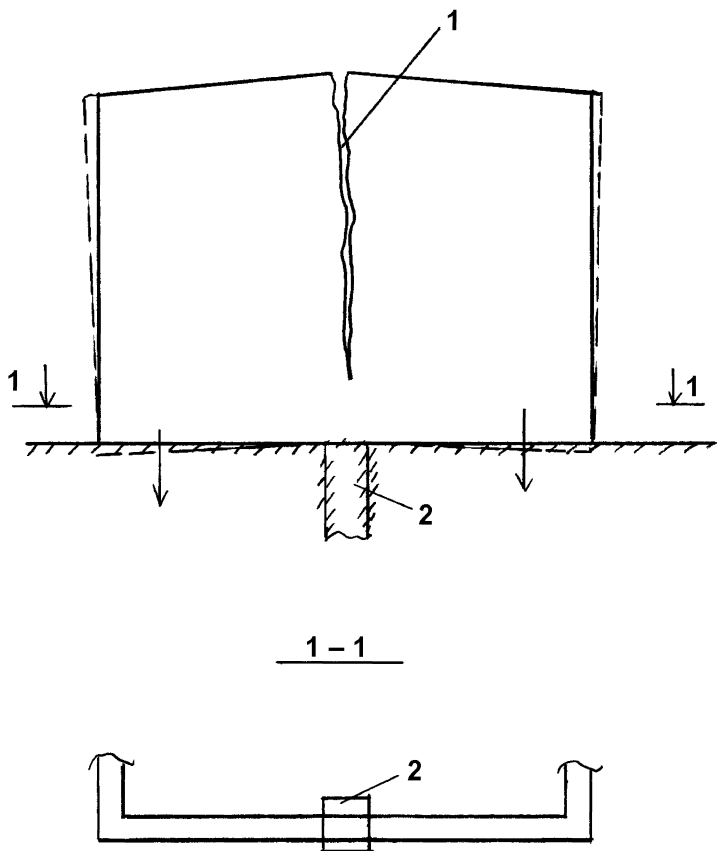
Трещина в стене здания над местом забетонированного колодца в грунте:
